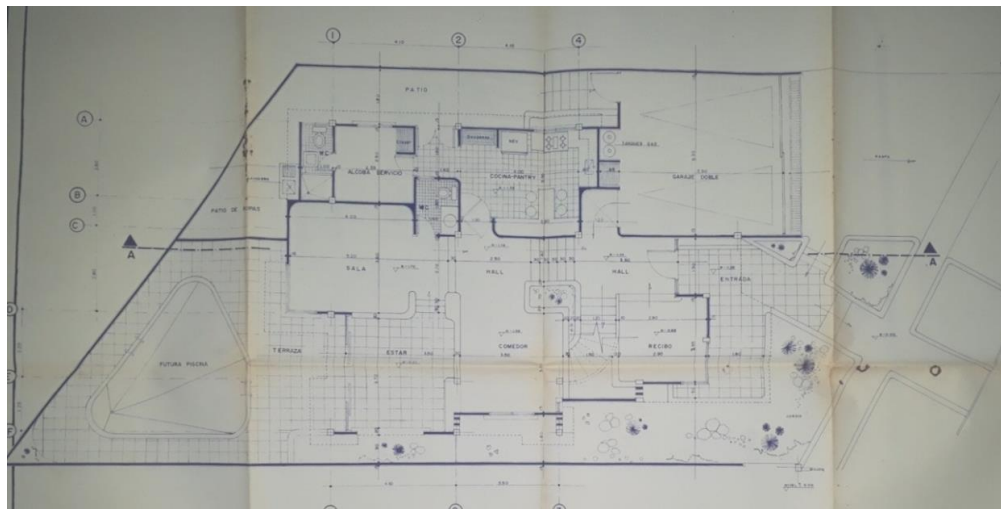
Planta arquitectónica 1 piso vivienda unifamiliar (1983)
